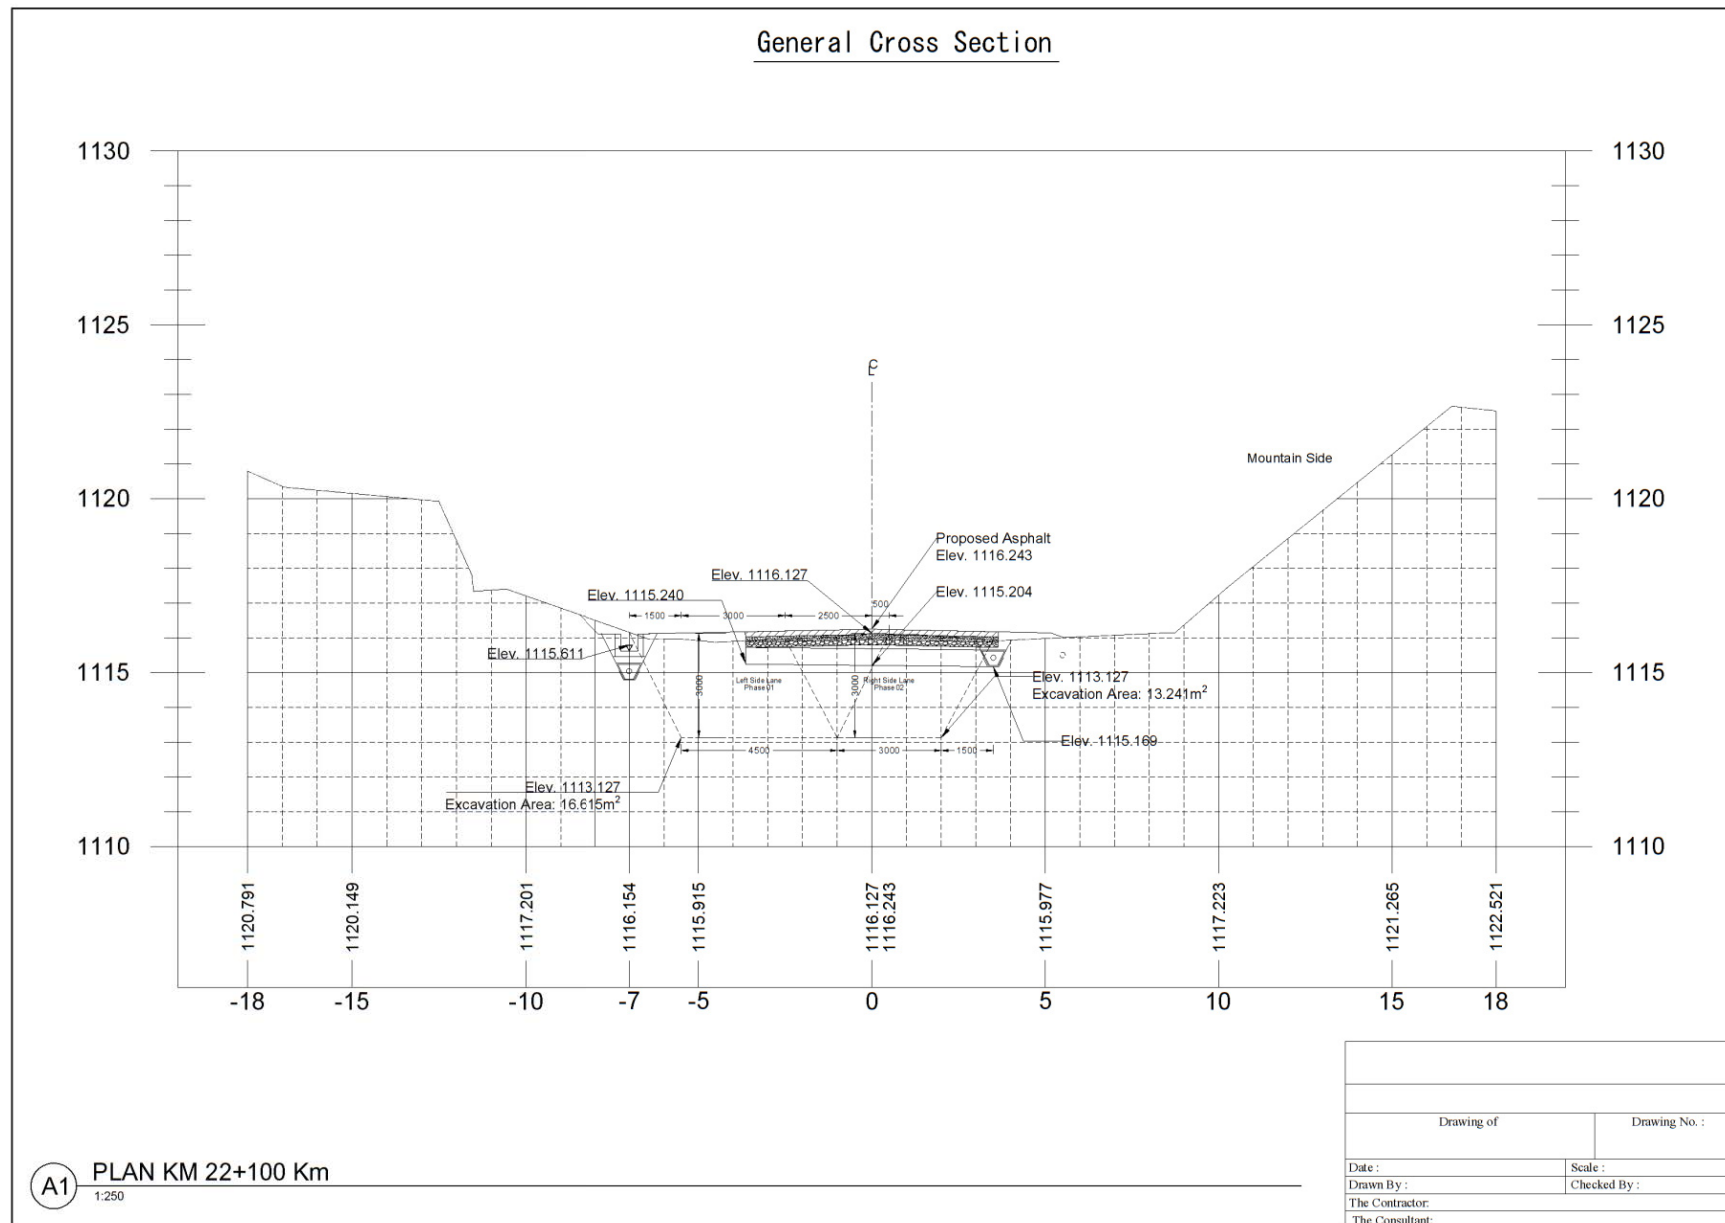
Sta.22+000a Vista estándar de la sección transversal (Sin escala)
